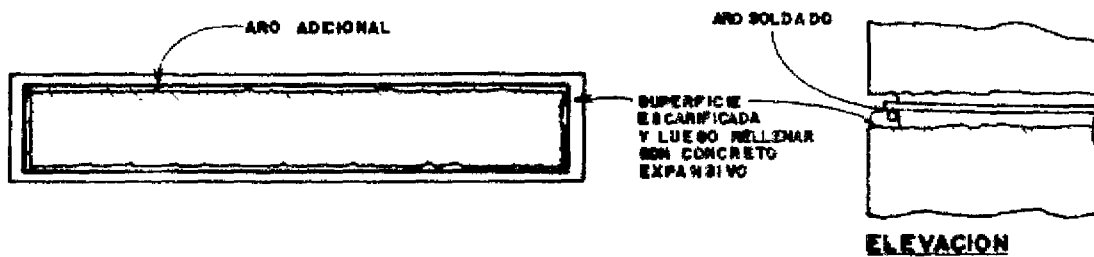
REFUERZO DE CONFINAMIENTO Y DE CORTANTE EN MURO EXISTENTE
